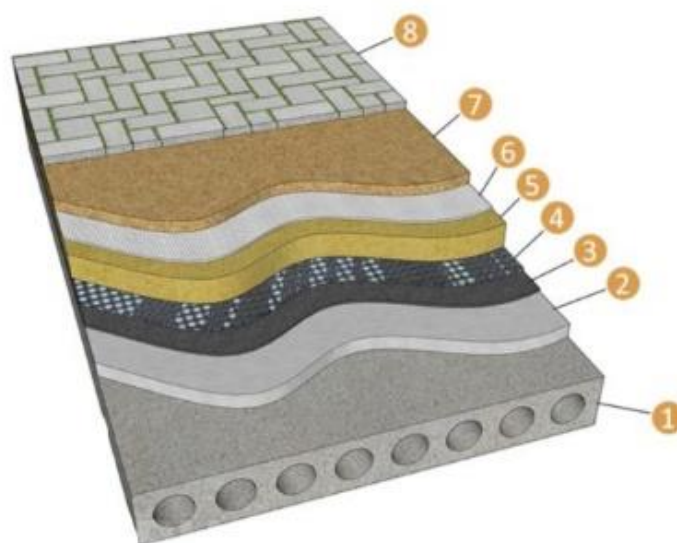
Терраса: 1 — плита перекрытия; 2 — бетонная стяжка; 3 — гидроизоляция; 4 — дренажный материал; 5 — утеплитель; 6 — геотекстиль; 7 — песчано-цементная смесь; 8 — тротуарная плитка
